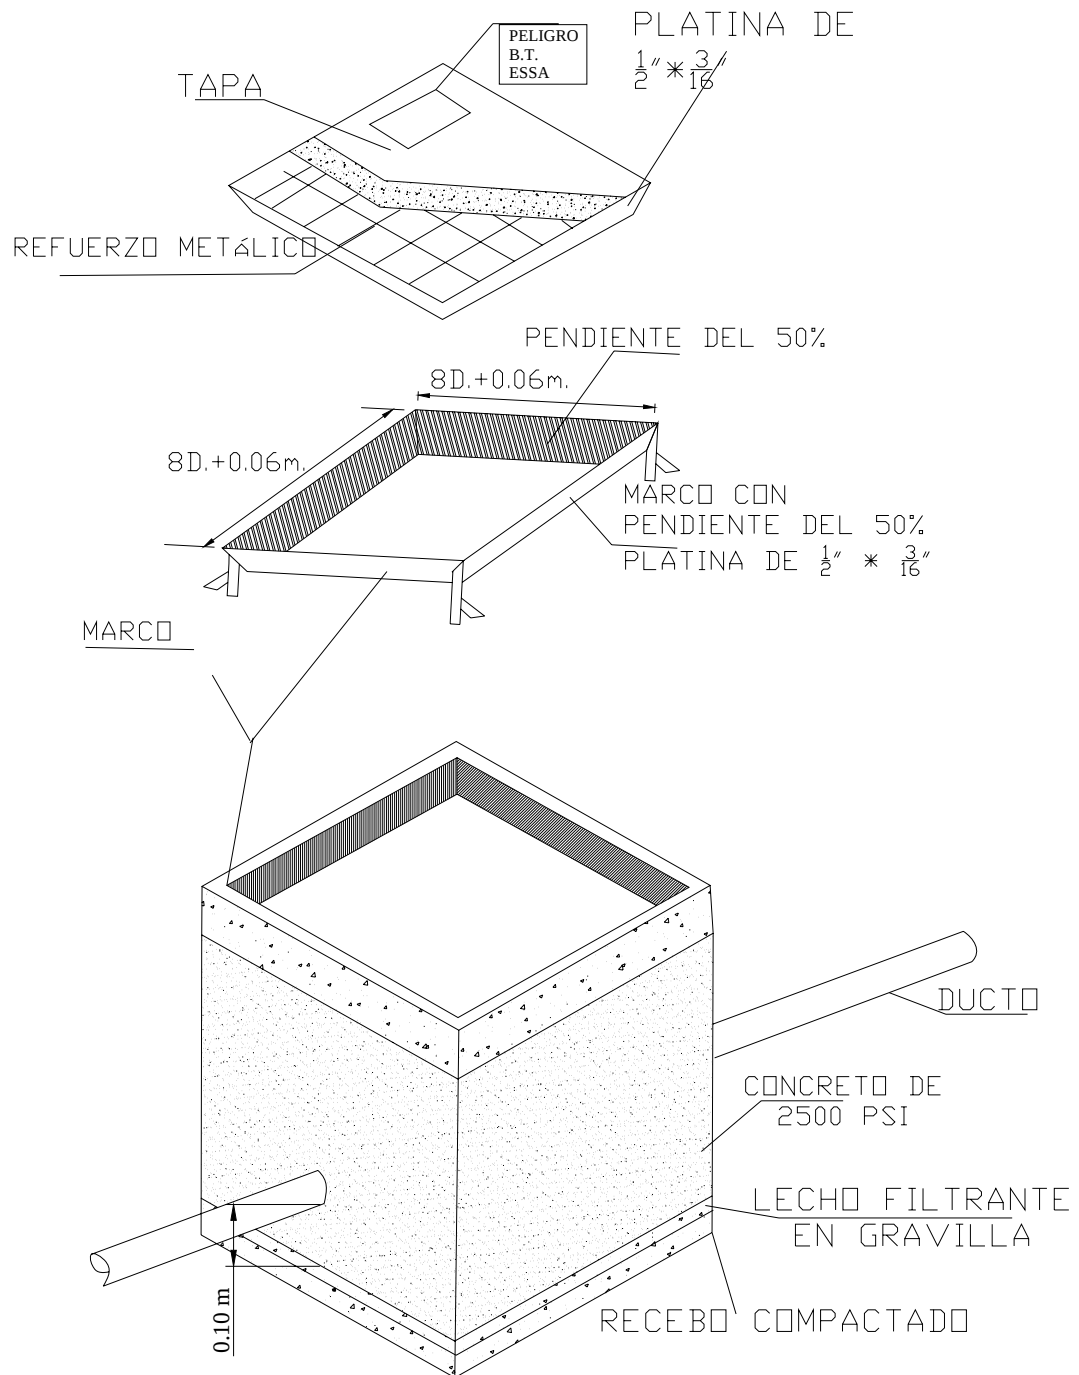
Caja de inspección en B.T. Vista isométrica
